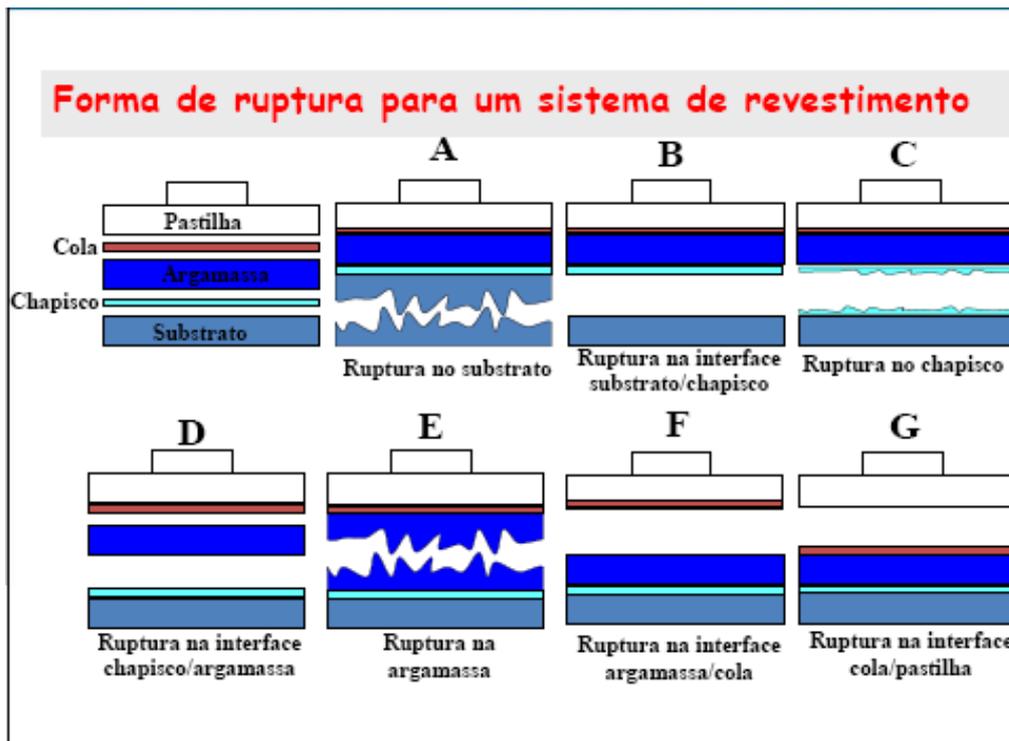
Rupturas do SRC- segundo (MENDES DA SILVA J.A. R; PROFº. DR. 2007)
